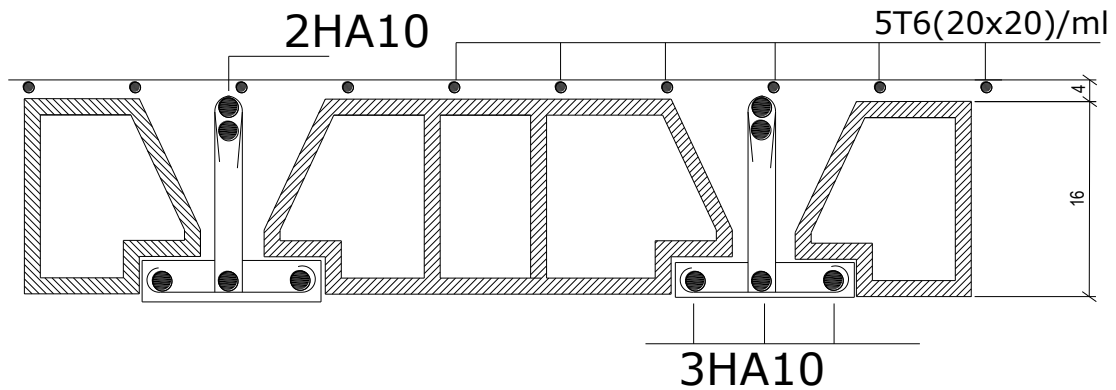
Schéma ferrailage du plancher en corps creux.
